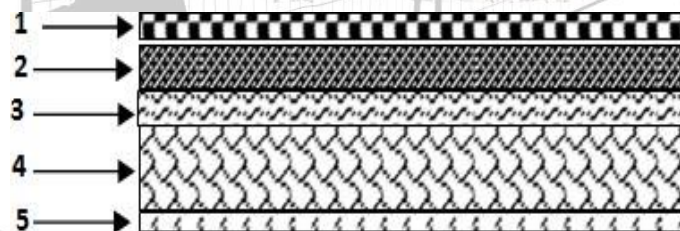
Coupe verticale d'une dalle pleine (balcons)
